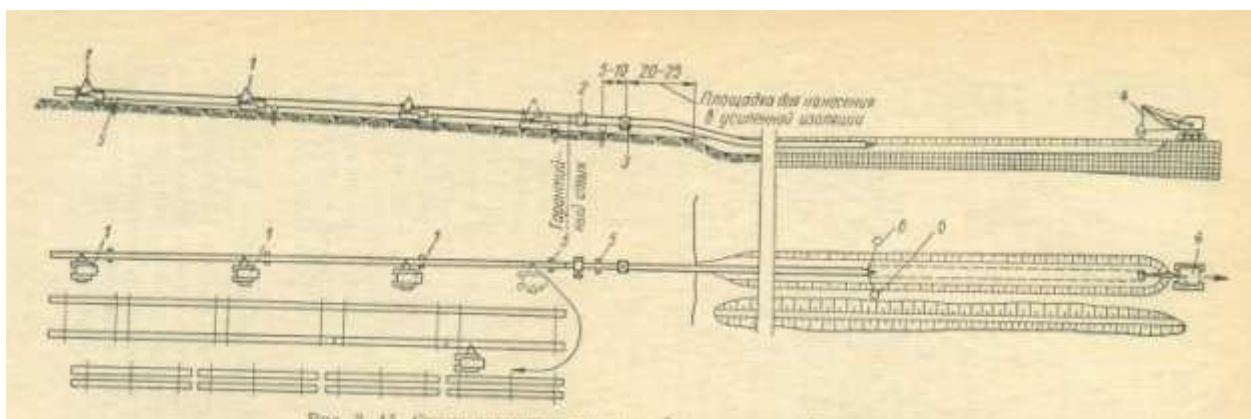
Схема совмещенного способа укладки трубопровода сплавом [12]:
